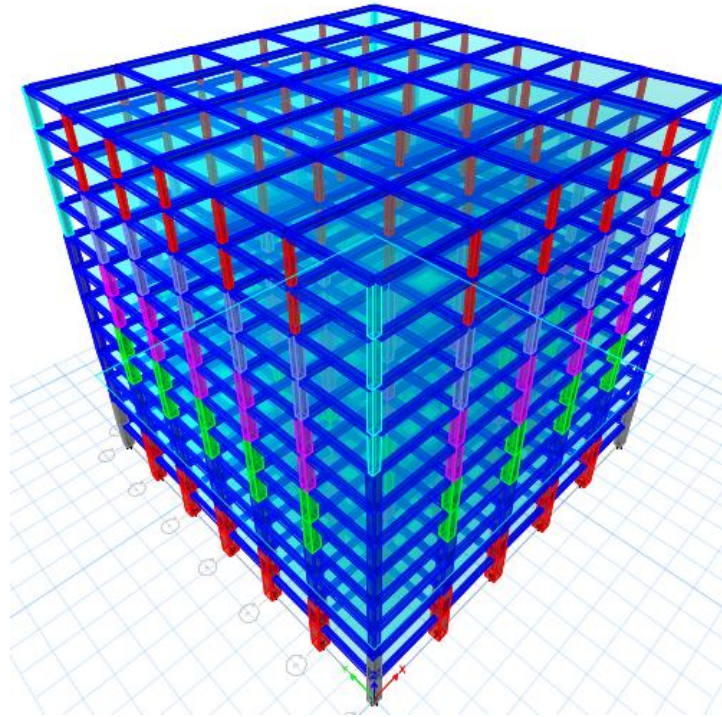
Esquema edificio de 12 niveles armado con losa maciza fuente Autor
